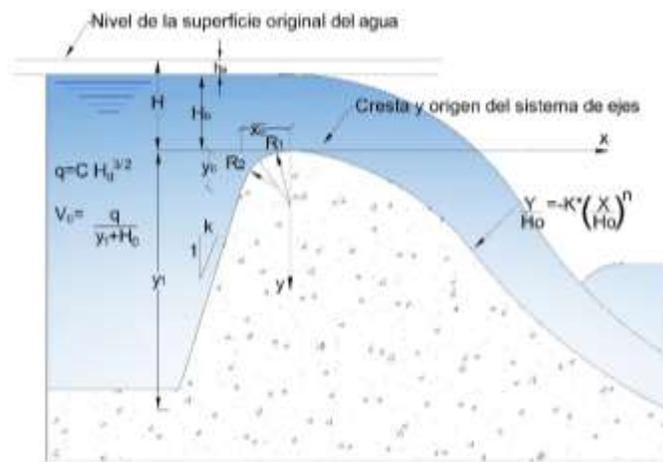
Elementos de los perfiles de cimacio con la forma de lámina vertiente
